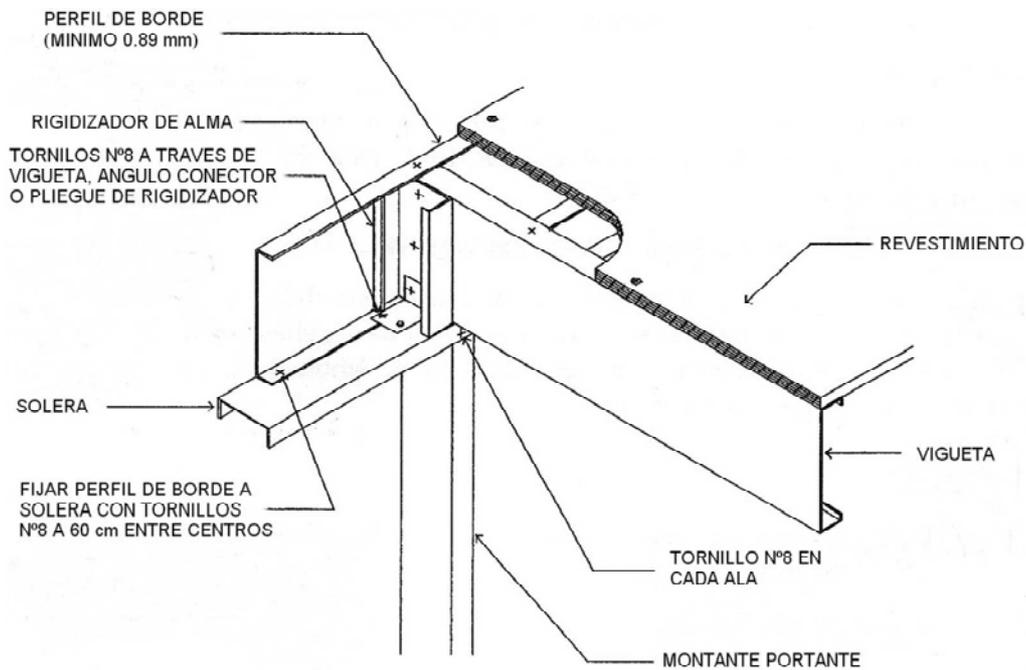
Detalle unión de forjado con muro resistente; Fuente: Manual de steel framing
